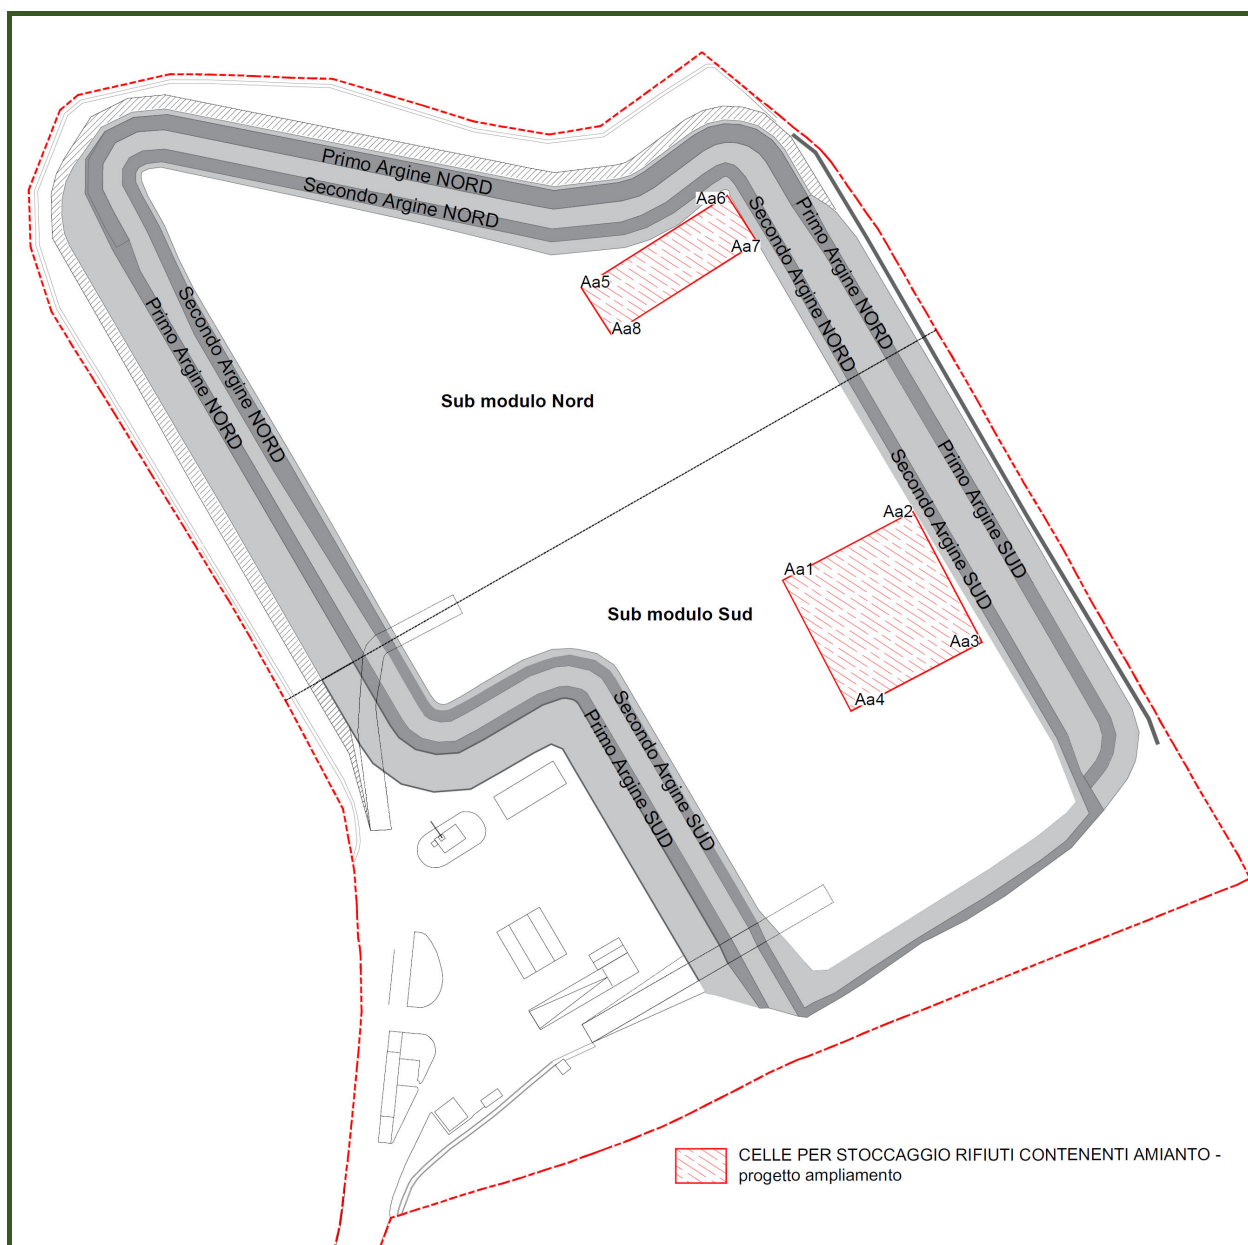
/I: Planimetria con ubicazione celle per RCA (ampliamento)
